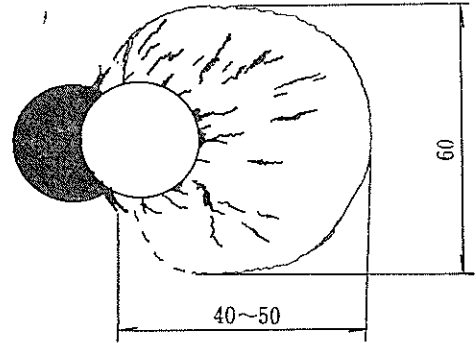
Pile No. 5, 3,289kg 載荷時の地表面破壊状況
